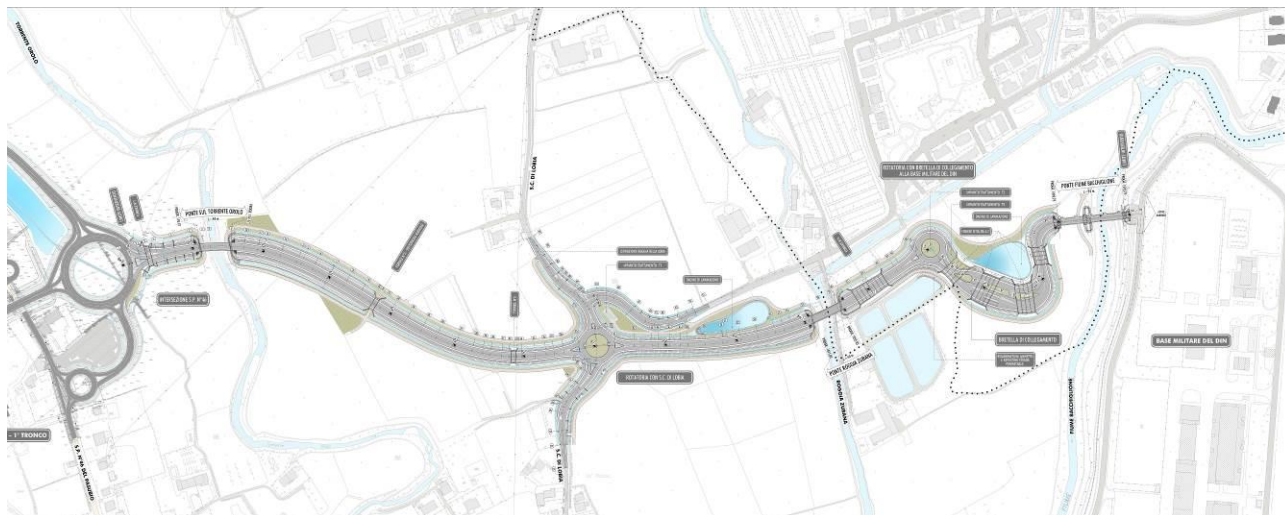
STRALCIO PLANIMETRICO DELL'INTERVENTO DI PROGETTO
